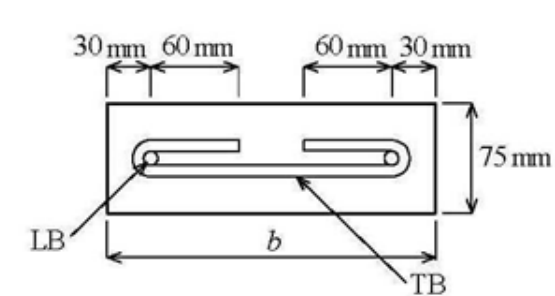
Sección transversal de una banda o vigueta de hormigón armado (Schacher, 2006)
